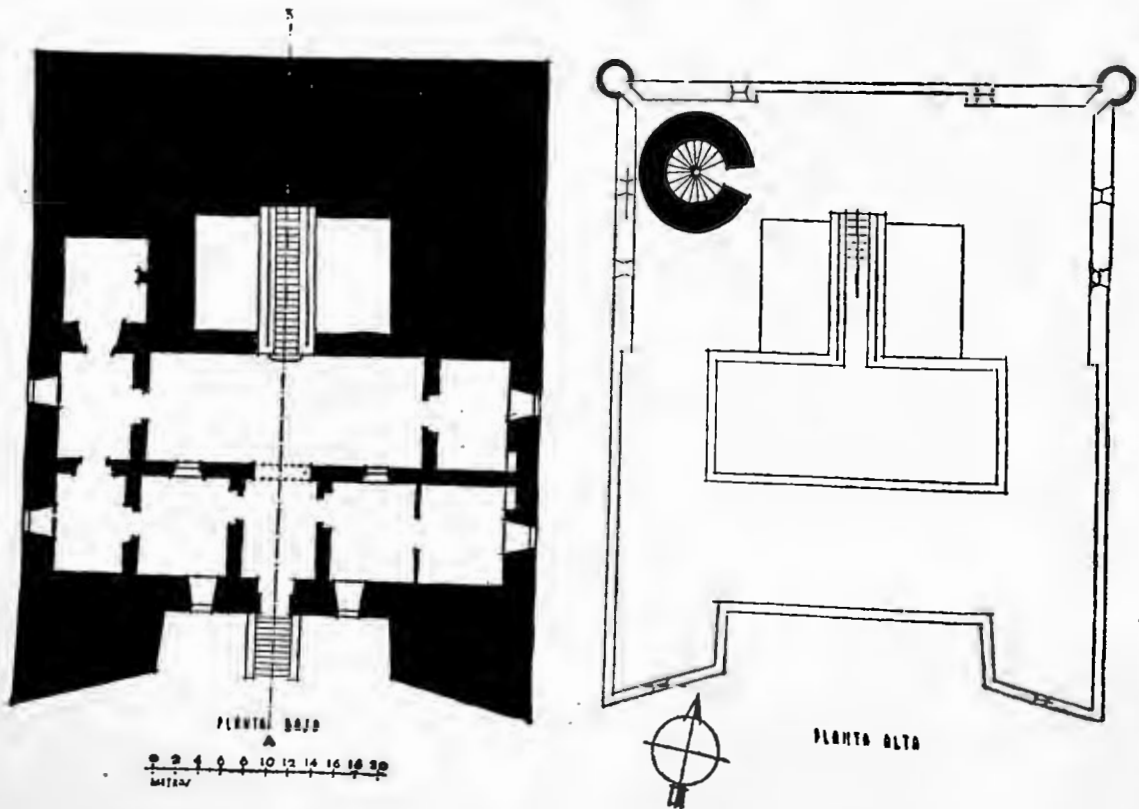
PLANTAS BAJA Y ALTA DEL REDUCTO DE SISAL
